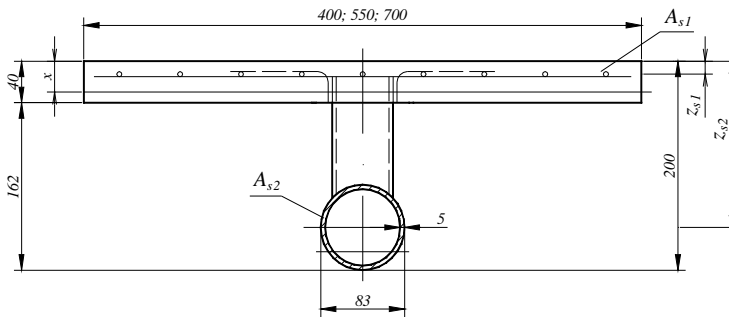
Розрахункова схема сталезалізобетонної балки з армуванням трубами серій Б-2-1, Б-2-2, Б-2-3
